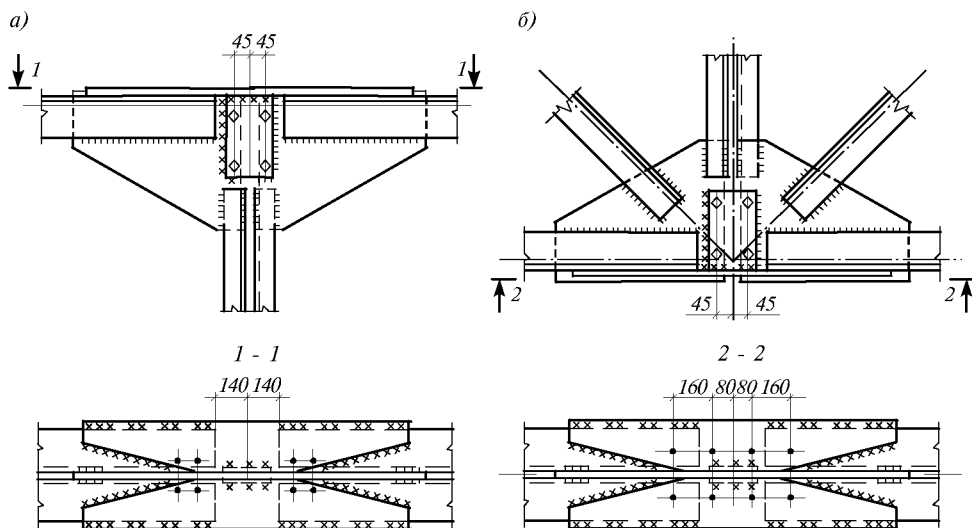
Монтажные стыки ферм из парных горячекатаных уголков
